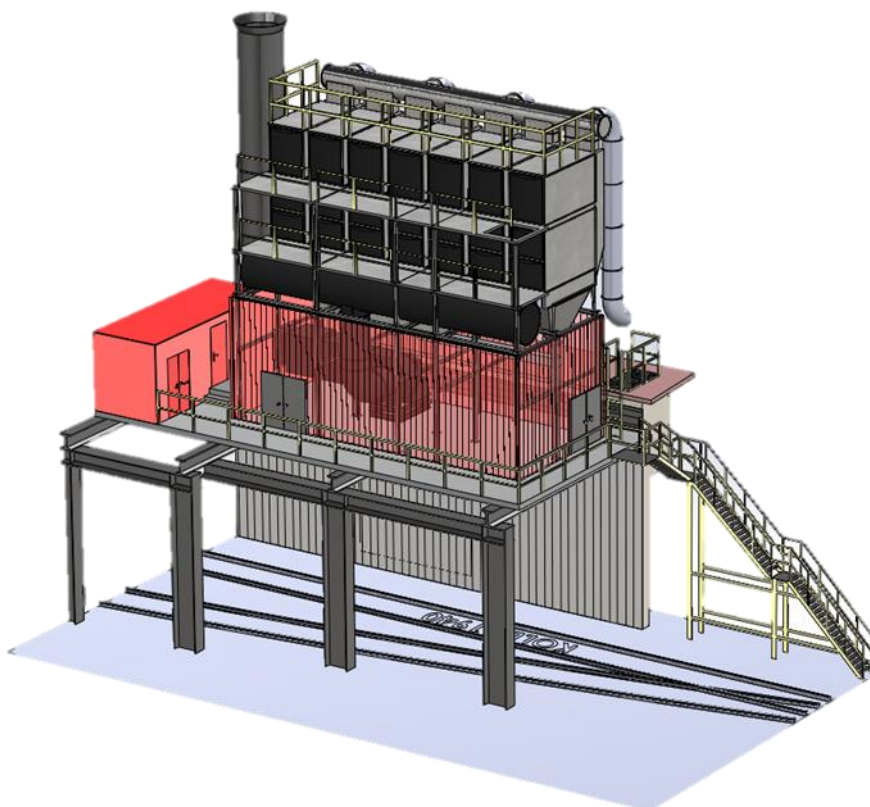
Odsávací přípravky pro odprášení zdroje „D“
